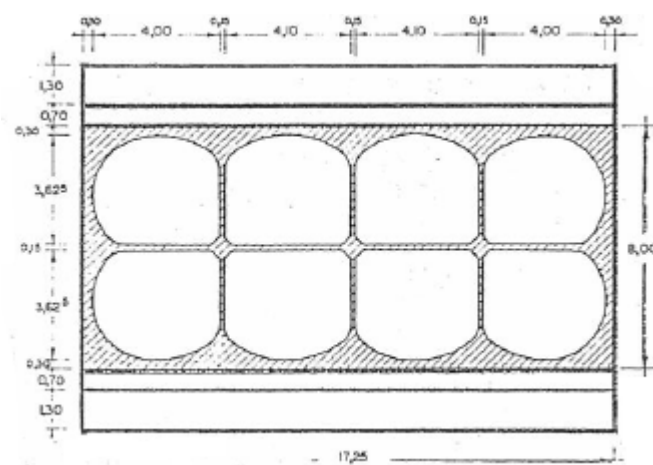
Esquema da Planta do Caixão (Pasajes)
